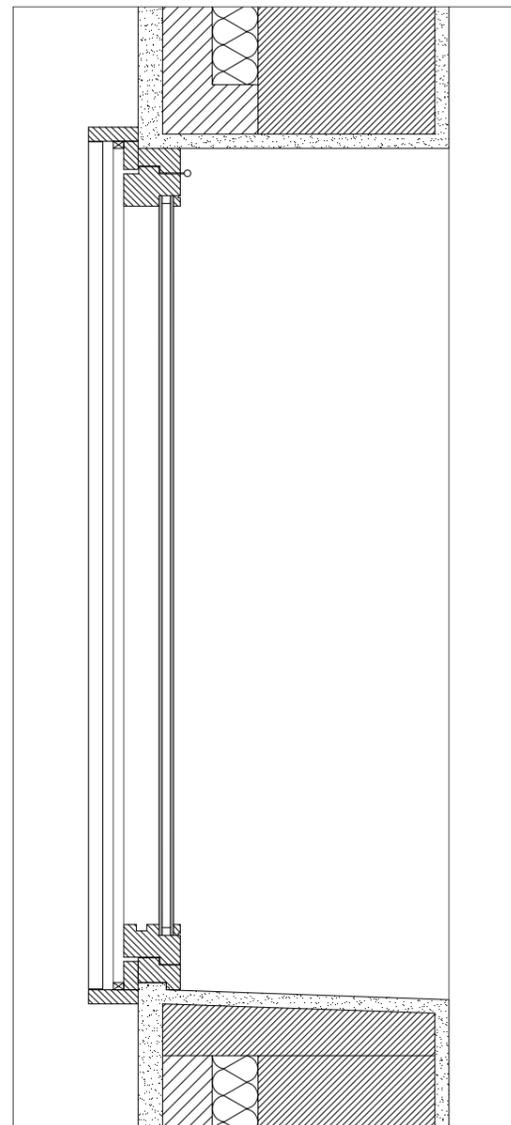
Planta do Vão-tipo — Nova Caixilharia | Escala 1:10
